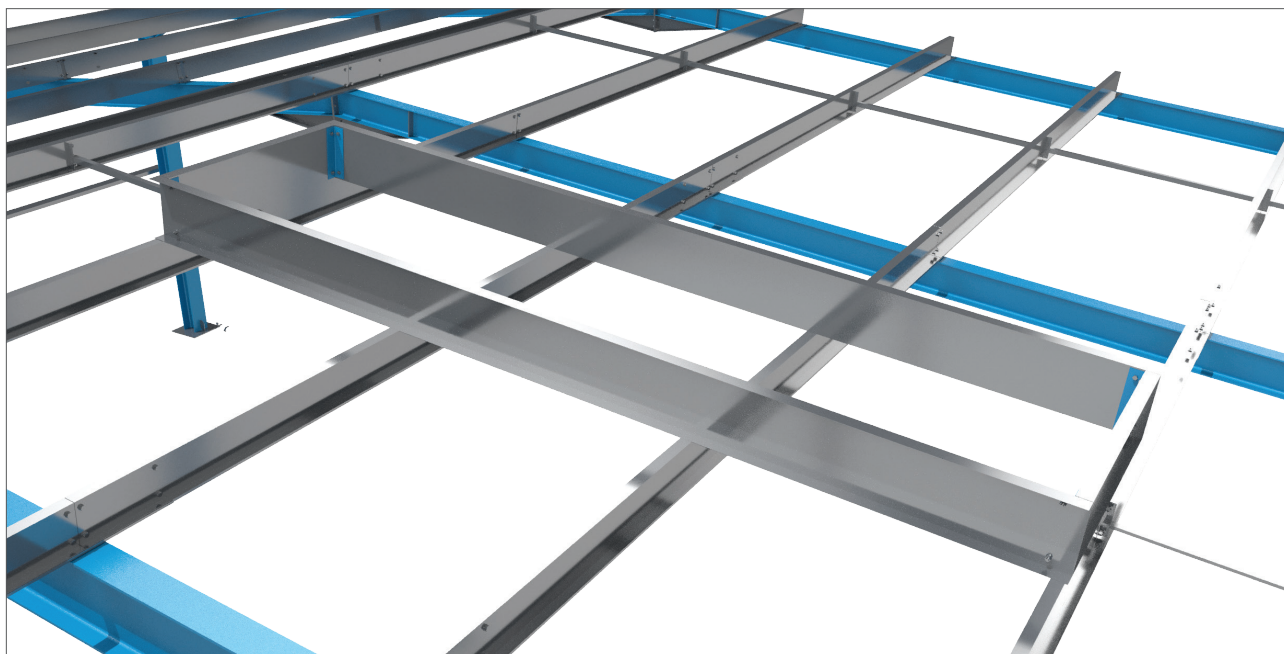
Detail připojení ztužující vzpěry k profilu světlíkové obruby. Standardní spoj je proveden pomocí šroubů M16.
